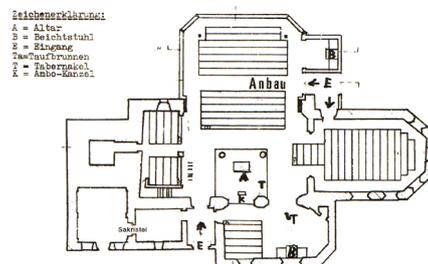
| Grundriss Pfarrkirche 1979, Marktgemeinde St. Martin i.M. 2005, 73
